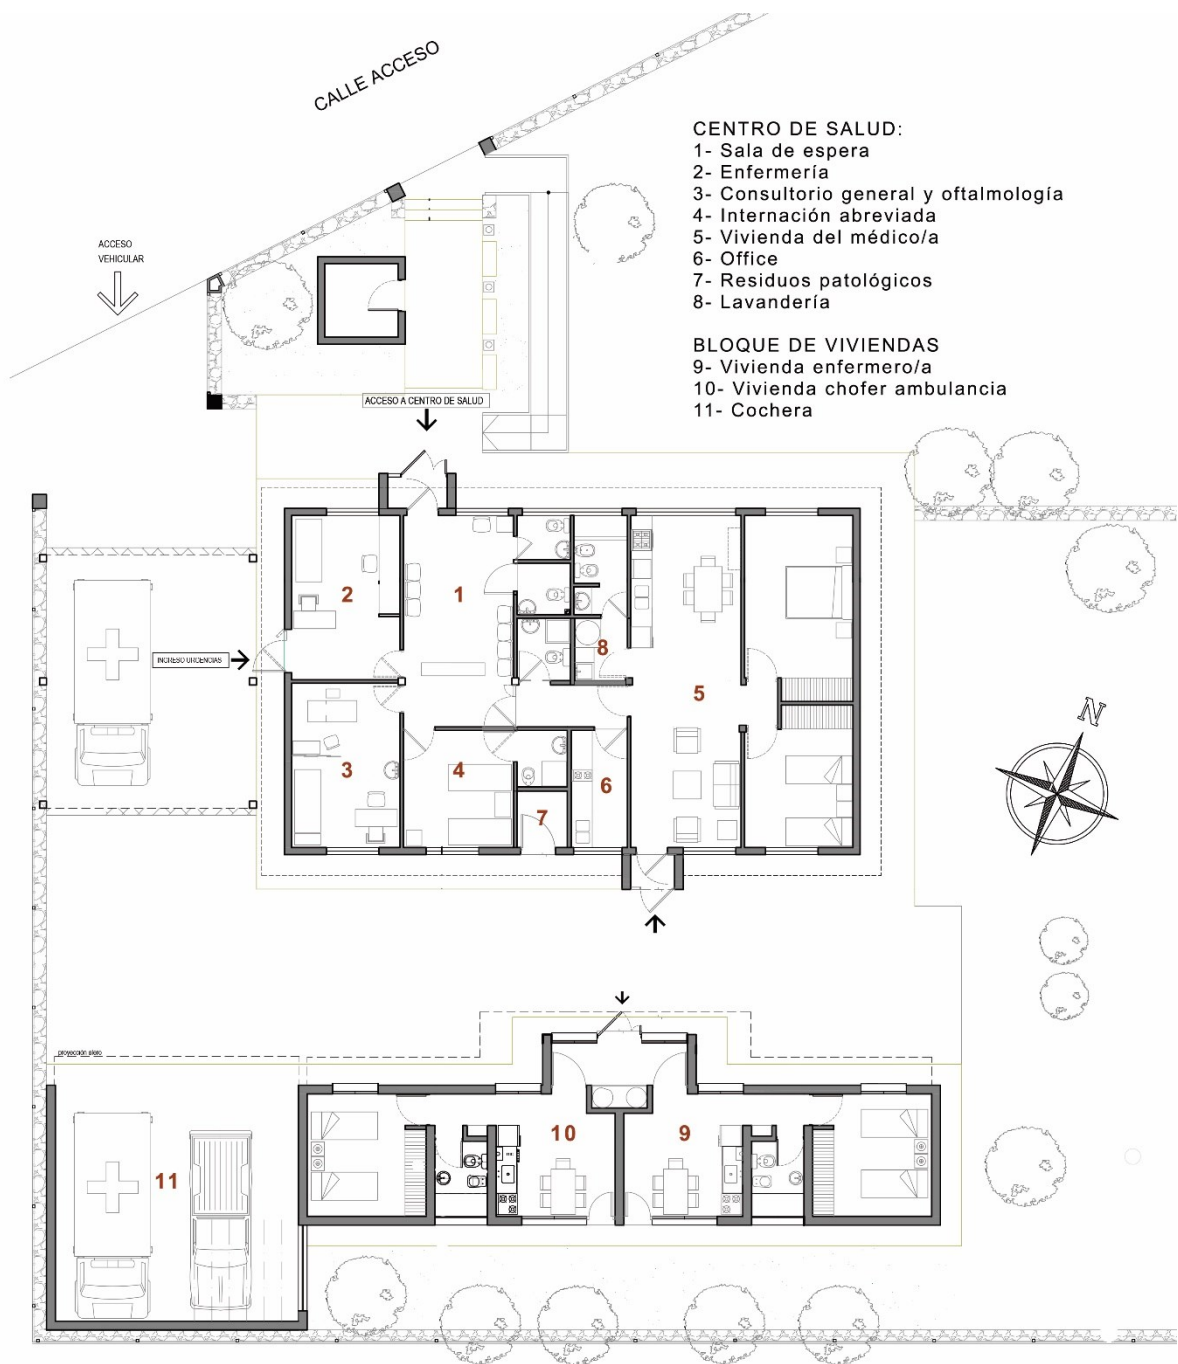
Planta del centro de salud y del bloque de viviendas. Fuente: Ministerio de Infraestructura, Vivienda y Transporte.
